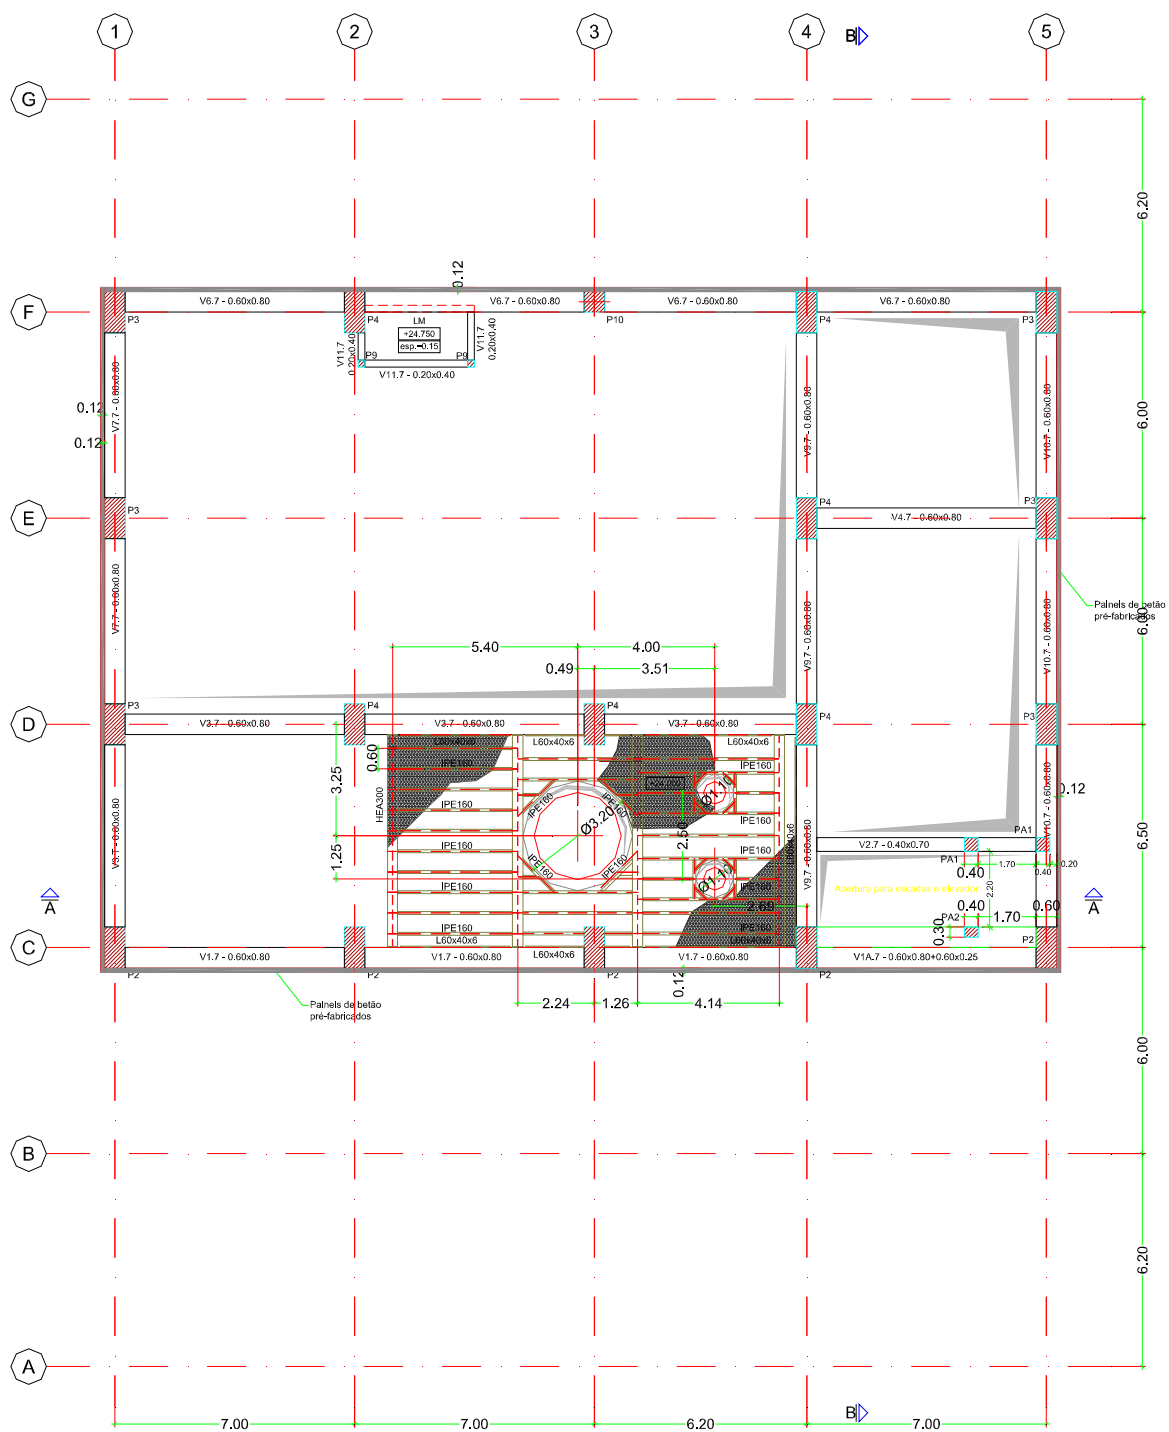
Planta estrutural às cotas +24,10 m e +24,75 m.
